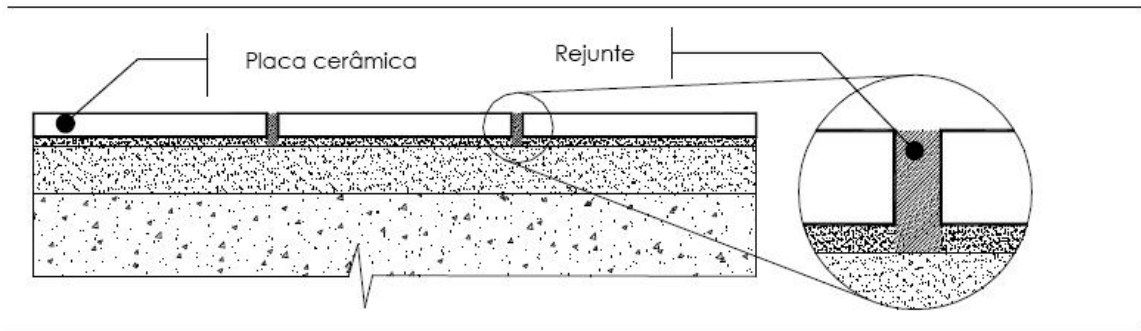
Acabamento plano de uma junta de assentamento (JUNGINGER, 2003).
